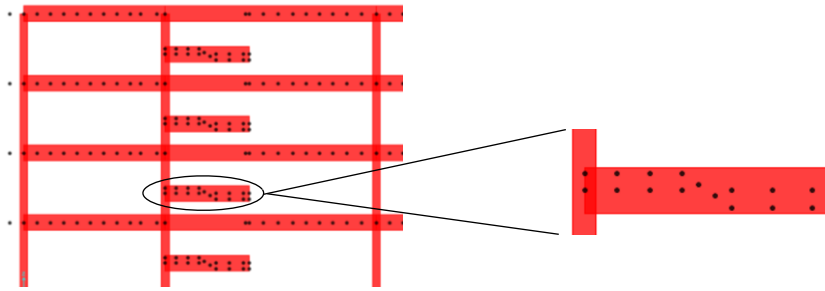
Modelação da ligação entre a laje de escada e viga da caixa de escadas.
